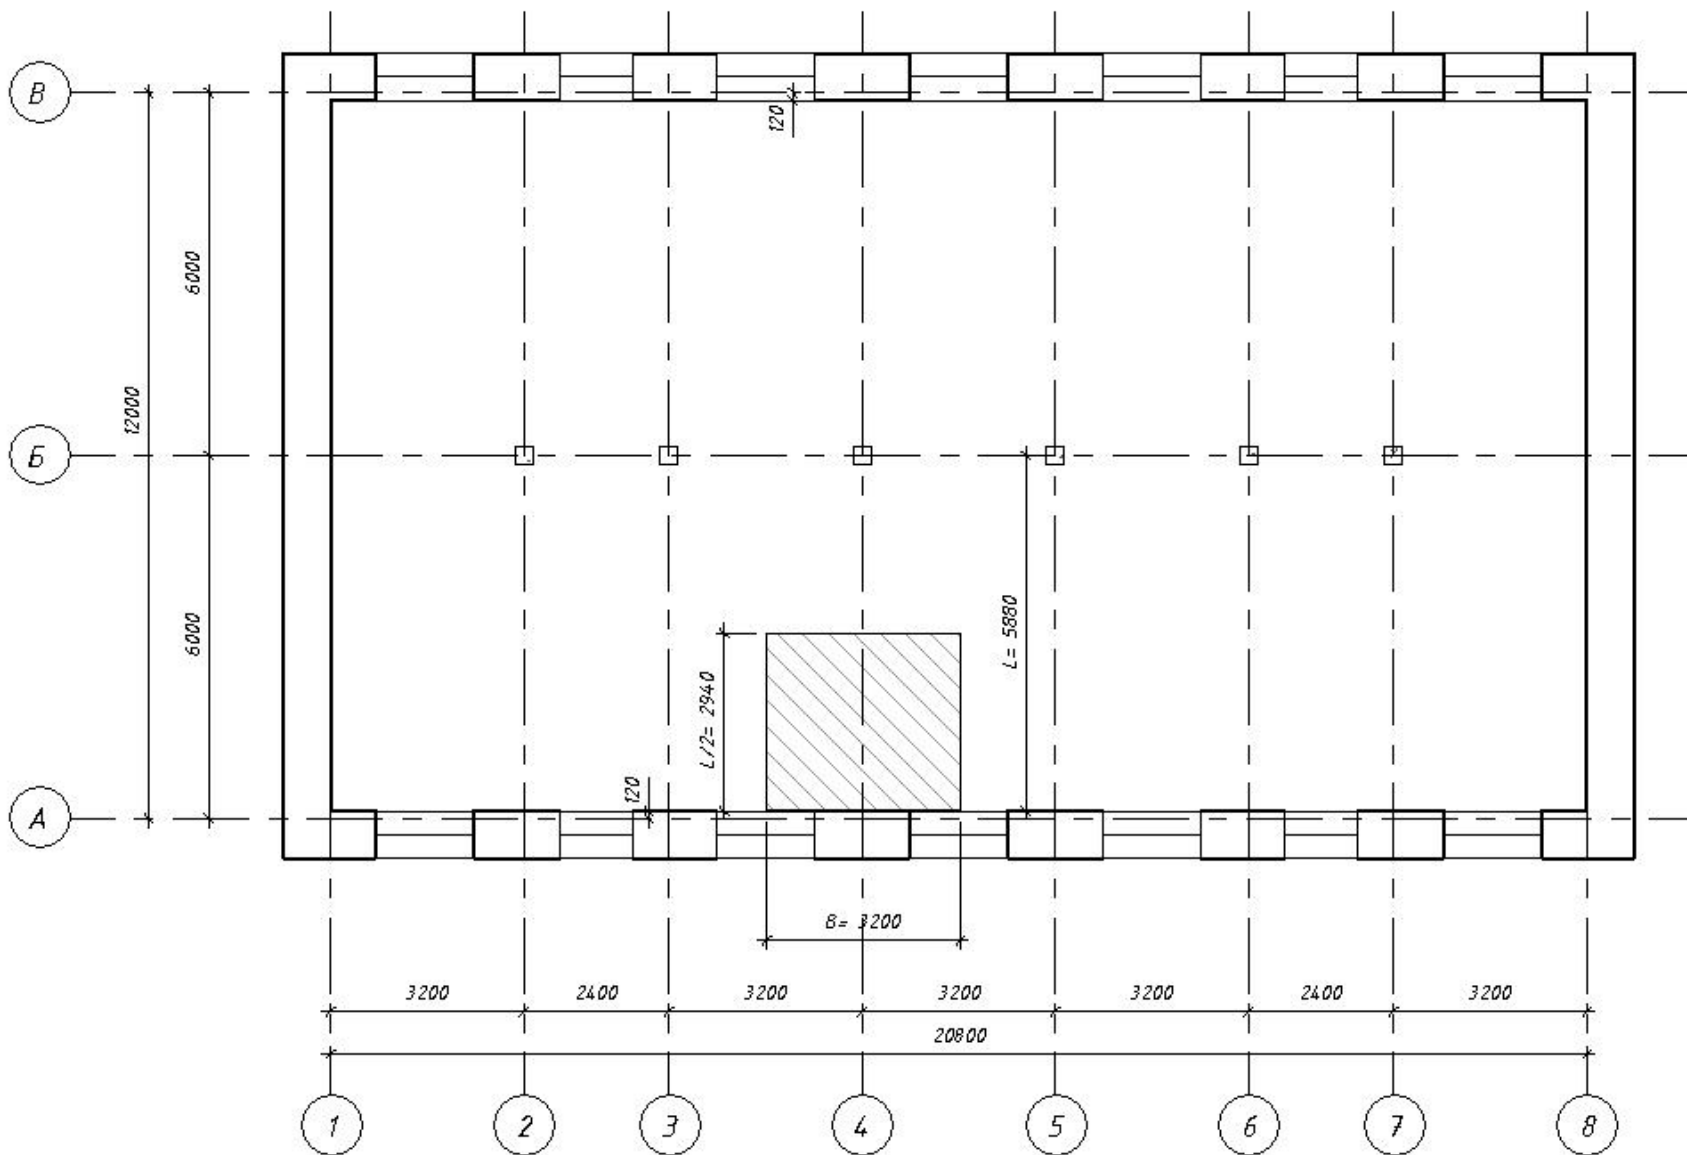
Размер грузовой площади при сборе нагрузок на стену здания
